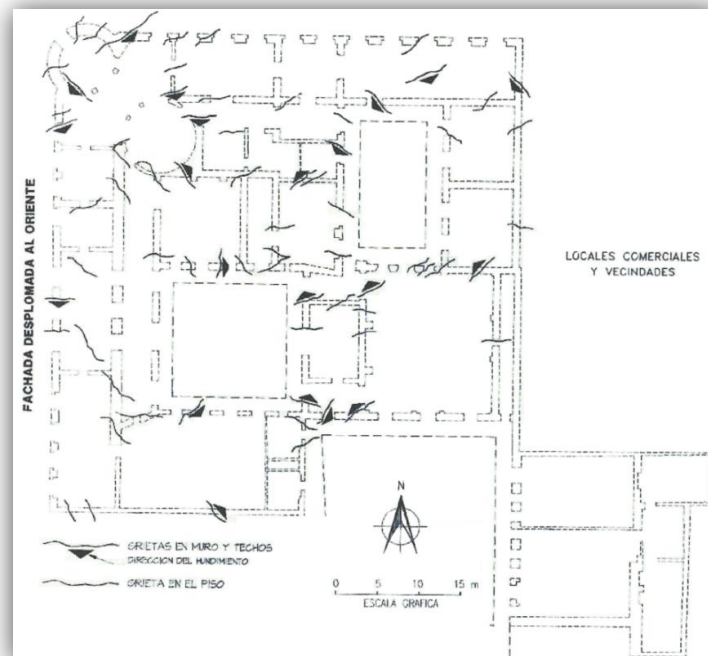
Levantamiento de grietas en planta del Palacio de la Autonomía (1995) [2.17].
